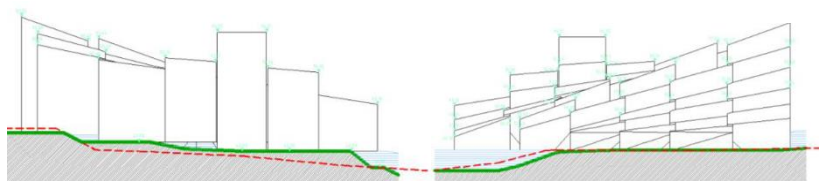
Perfis norte e sul do loteamento proposto (Fonte: EIA – julho de 2021).
